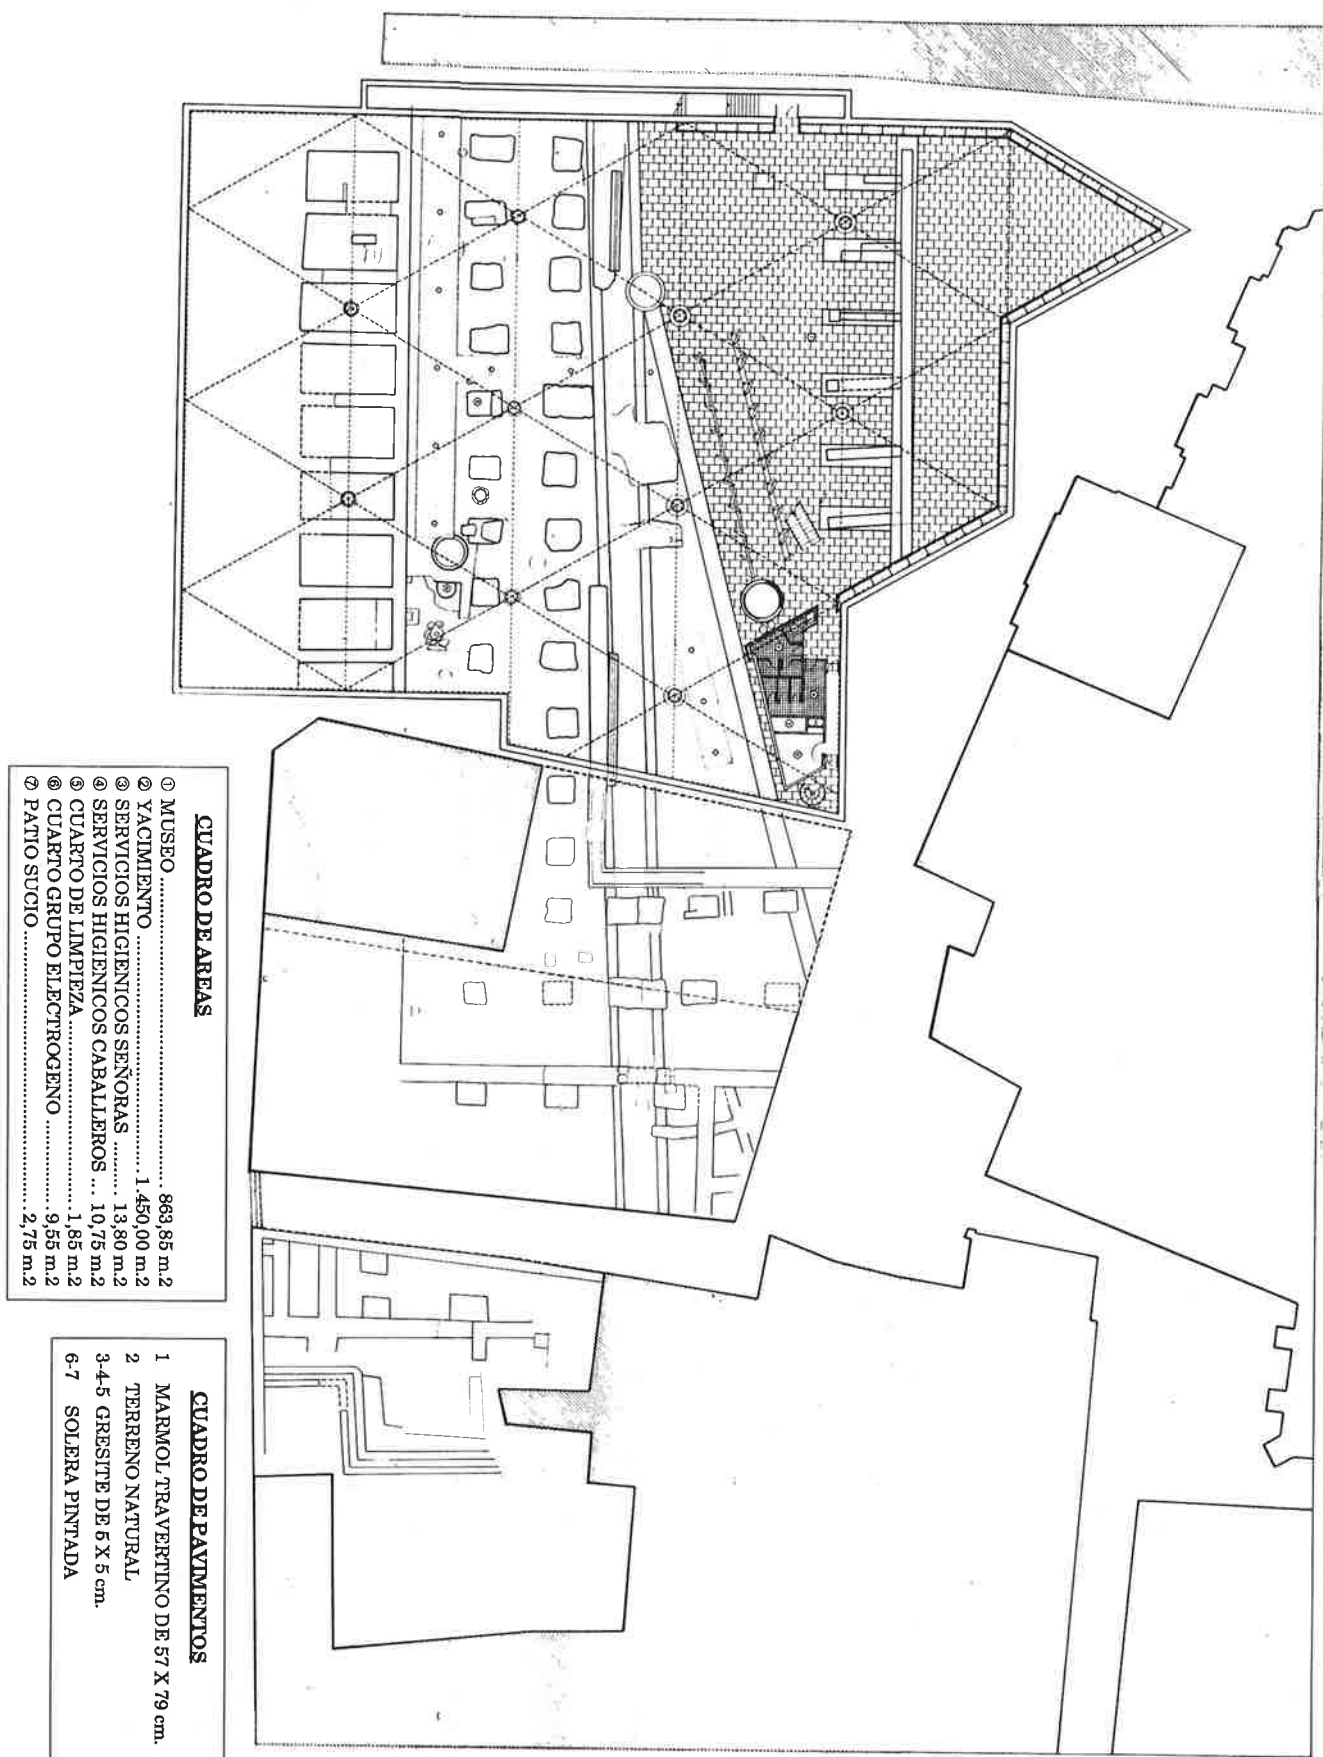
Plano n.º 17: Visión planimétrica de las instalaciones previstas al nivel de la Sala-Museo.
